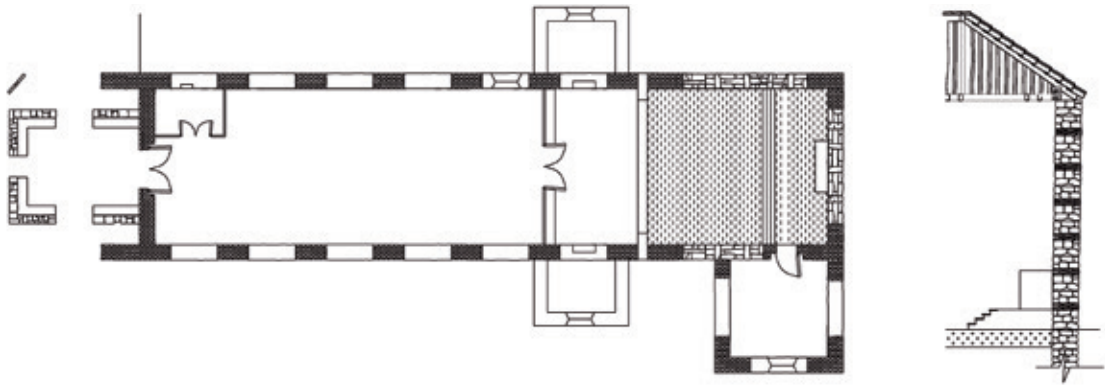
Corte longitudinal. Levantamiento de la iglesia de San Pedro de Iguaque-Boyacá construida en tapia rafada con adobe. Autor: A. Chica S., 2009.
